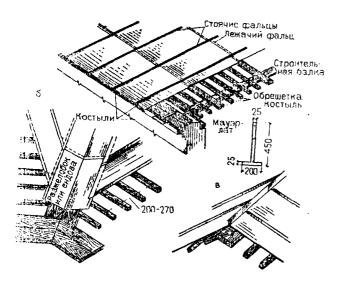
Стальная кровля a — карнизный свес; b — ендова: b — конек
